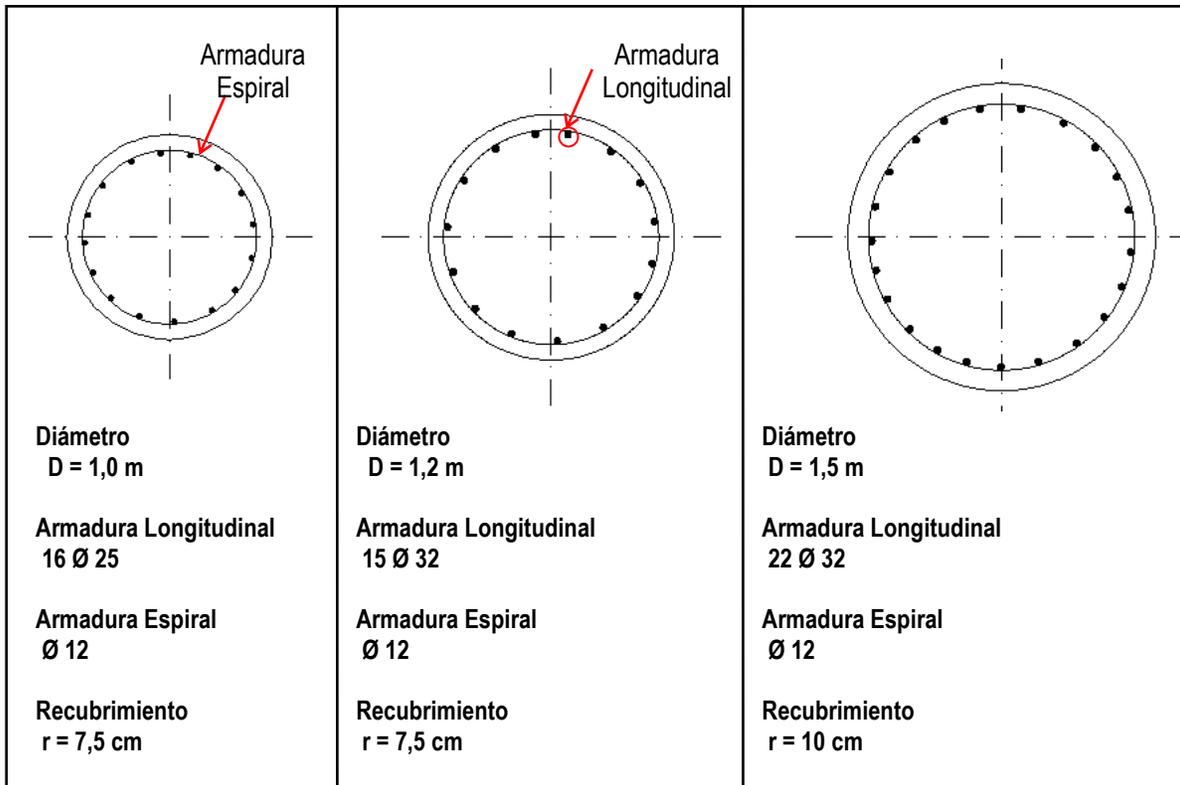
Corte transversal de pilotes pre-excavados con armaduras típicas.
